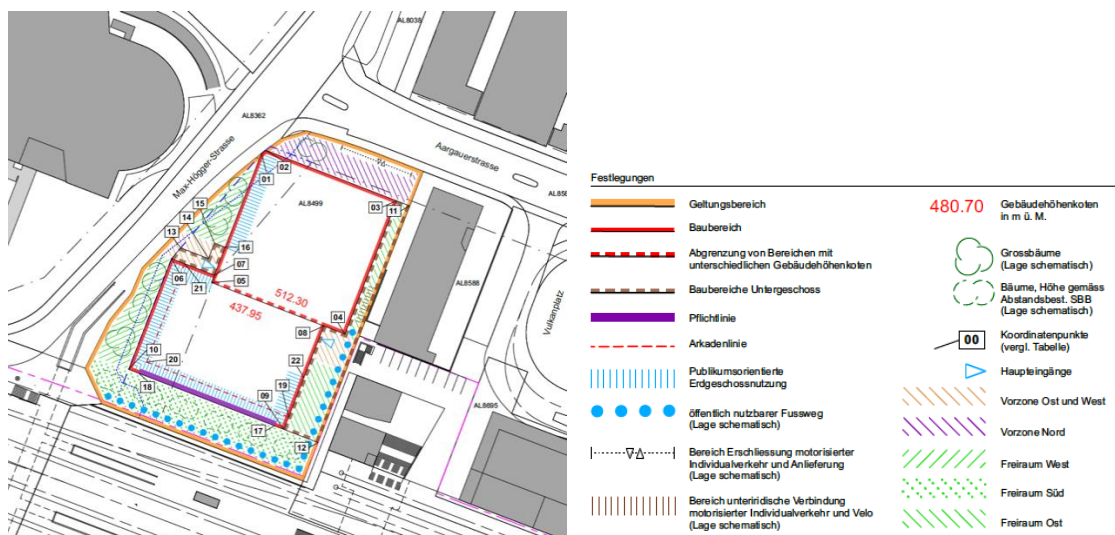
Situationsplan Privater Gestaltungsplan «Areal VZA1»
